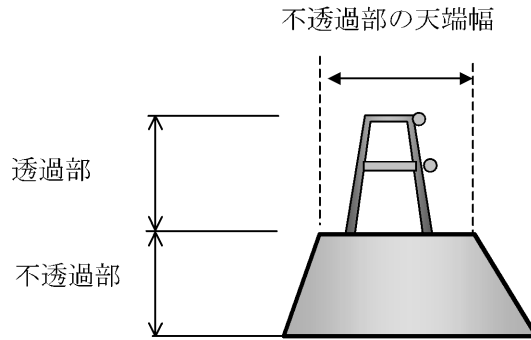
部分透過型砂防堰堤越流部側面図(例)
